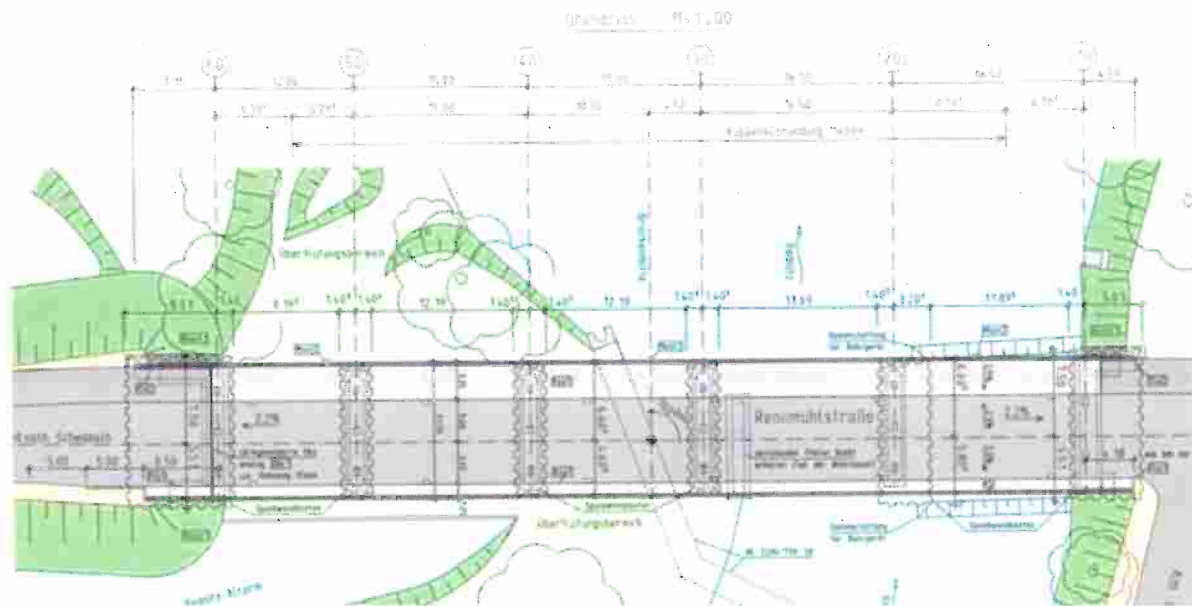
Lageplan mit Darstellung der Baubehelfe
